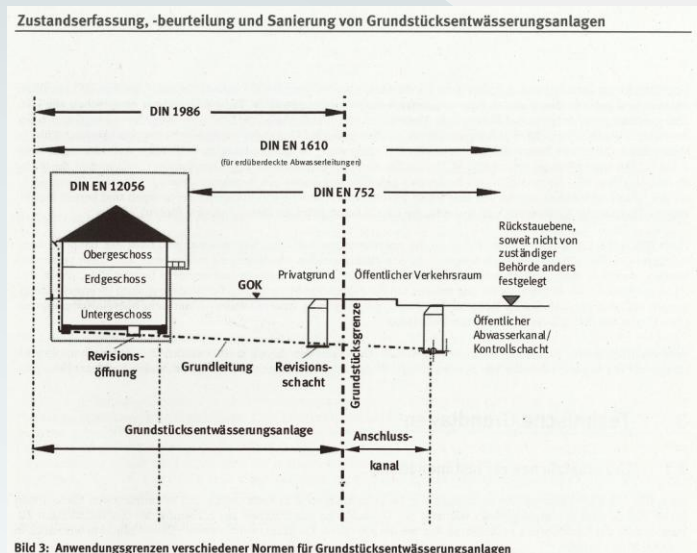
Anwendungsgrenzen verschiedener Normen für Grundstücksentwässerungsanlagen
